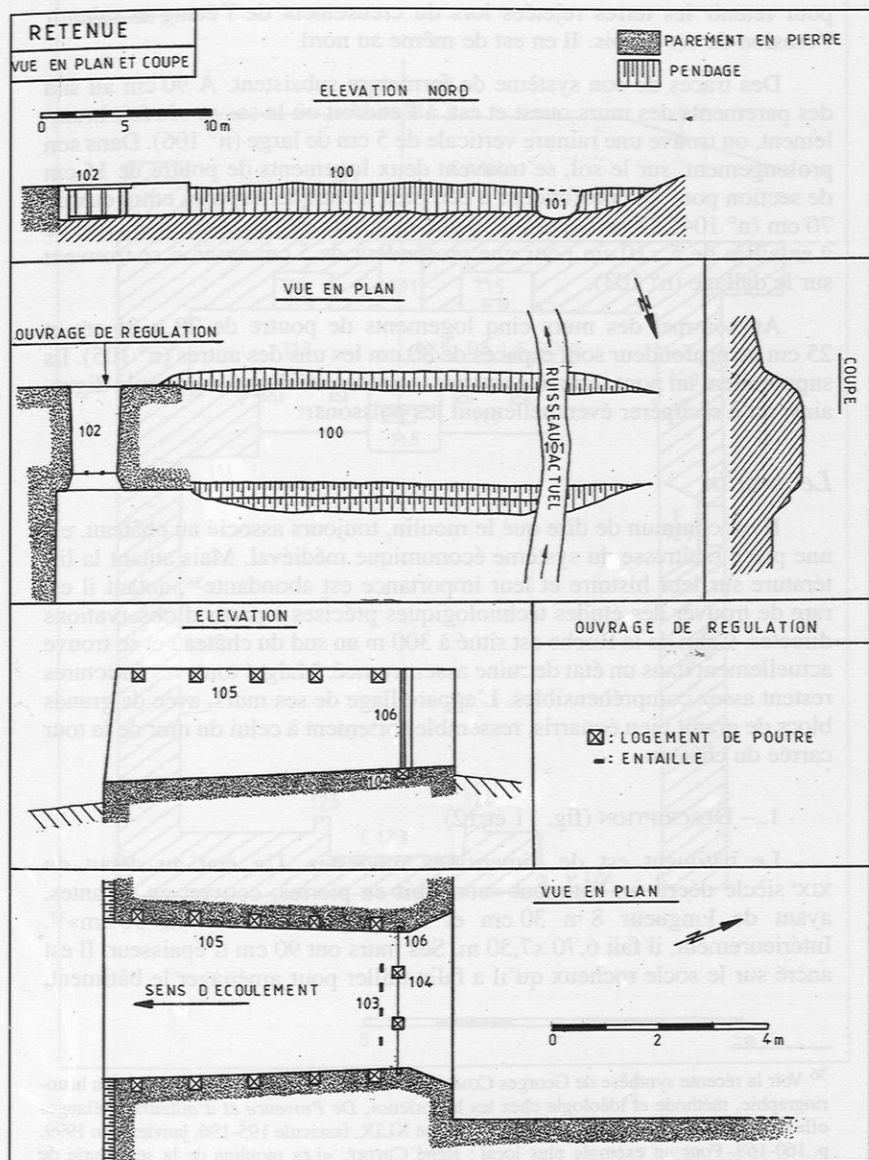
Plan et coupe de la digue et de son ouvrage de régulation.
